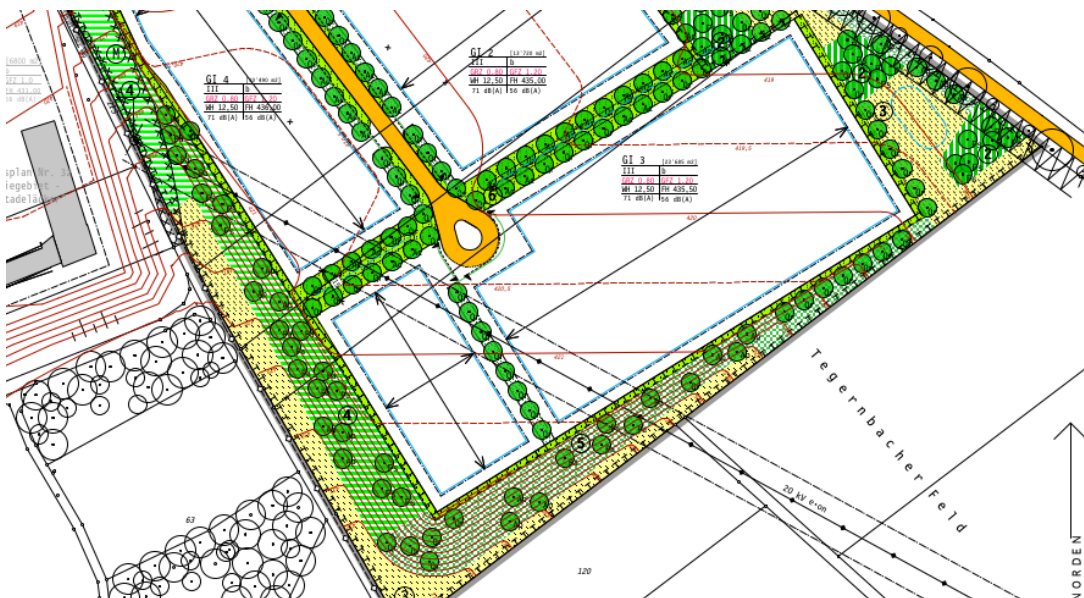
3. Änderung des BP „Ziegelstadeläcker II“, Ausschnitt Planzeichnung⁵
